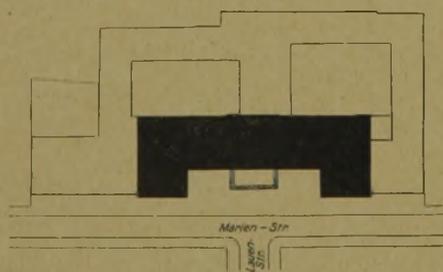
Lageplan mit Angabe der Erweiterungsmöglichkeit. M. 1:1000.
